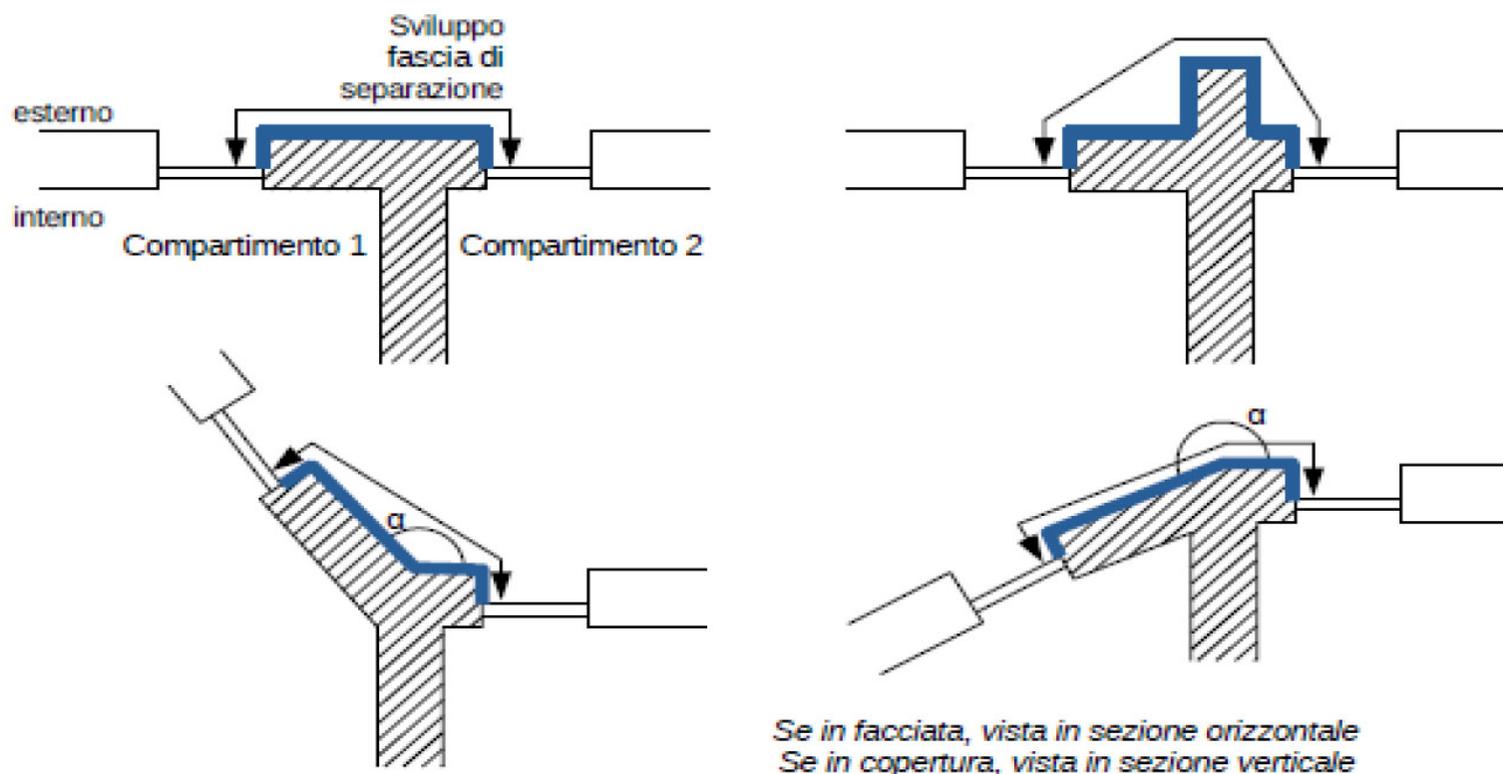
Esempi di fascia di separazione verticale in facciata o in copertura
